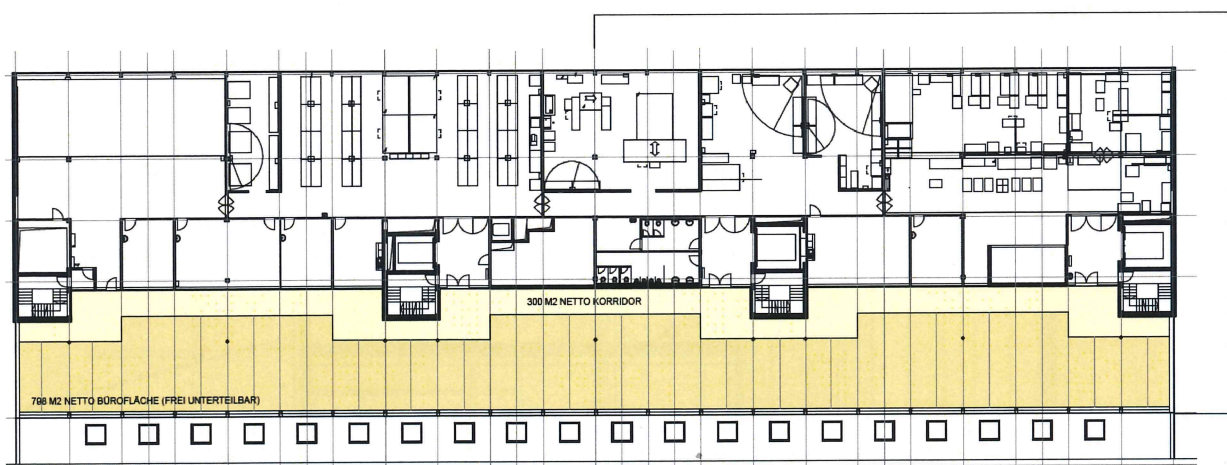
Variante 1 Grundriss 1.OG
